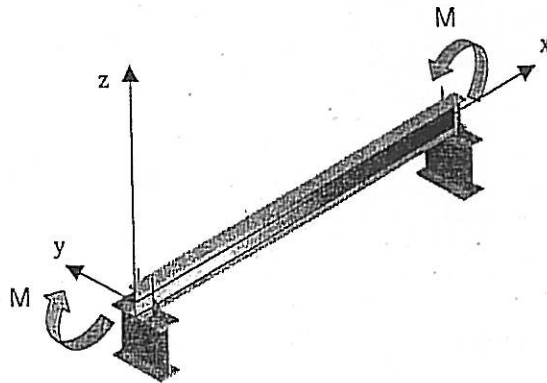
Viga tridimensional simplesmente apoiada, sujeita a momentos nas extremidades.
